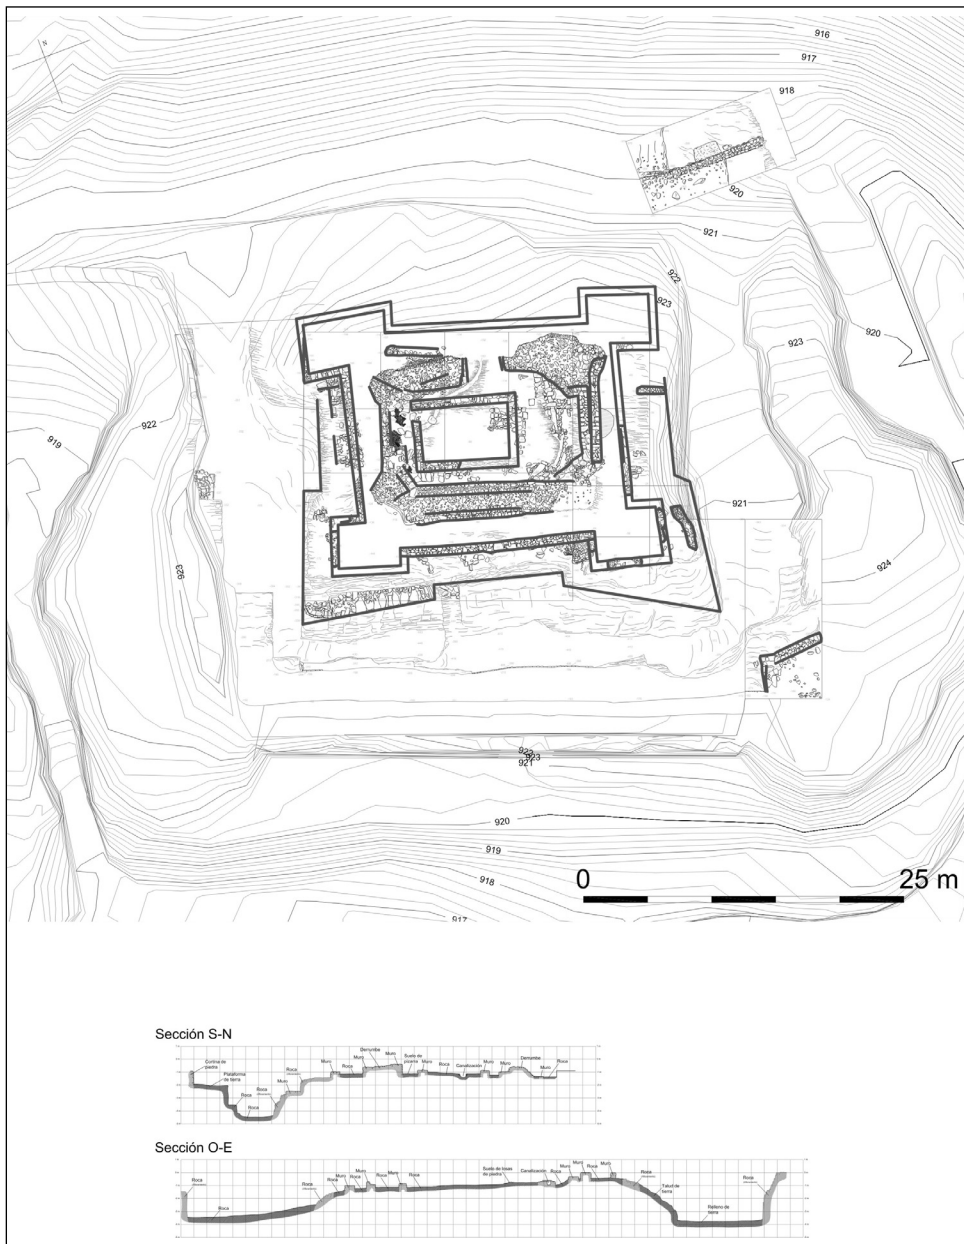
Planta general del Fuerte de San Carlos, con recreación de las líneas directrices de los muros y secciones transversales.
